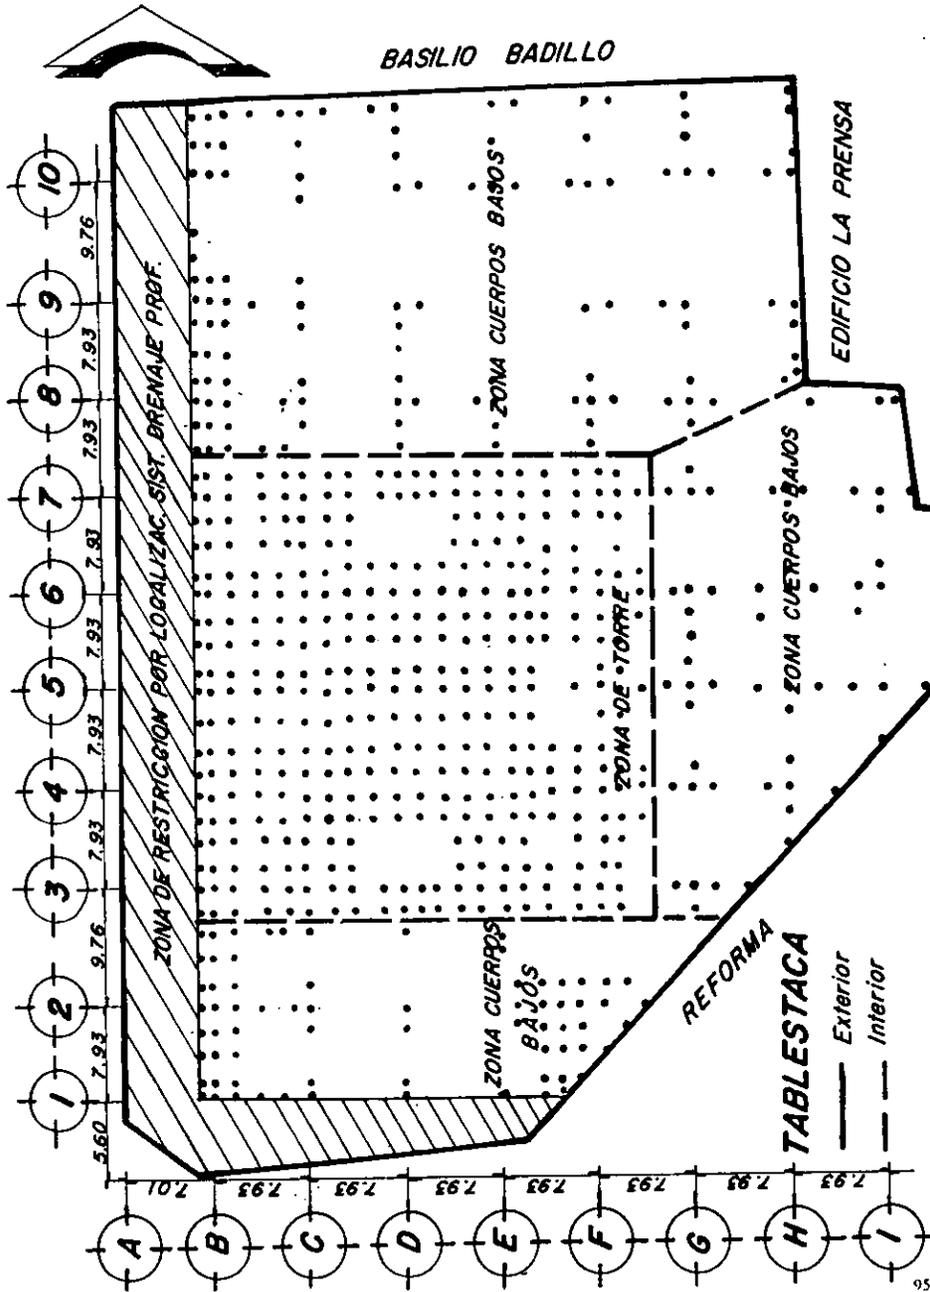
LOCALIZACION DE PILOTES Y TABLESTACA
